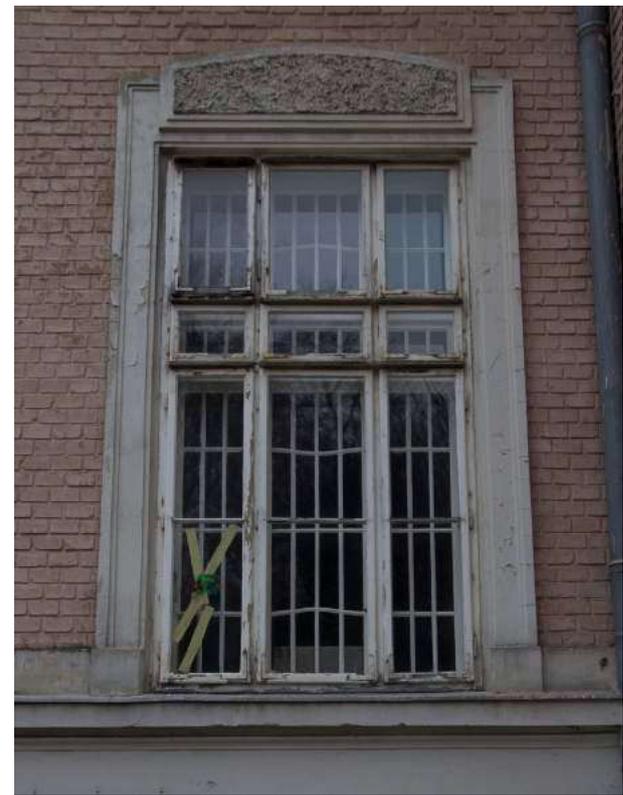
Fenster sind gut erhalten, benötigen aber eine Sanierung
